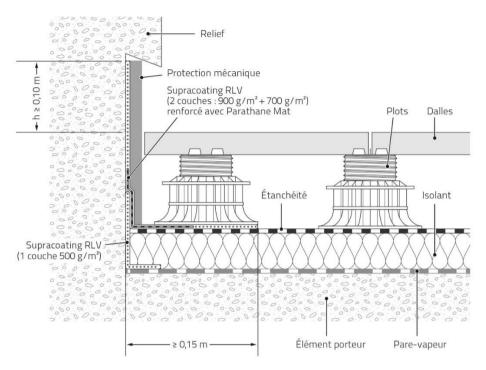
Protection par dalles sur plots : niveau fini des dalles en-dessous du haut des relevés
